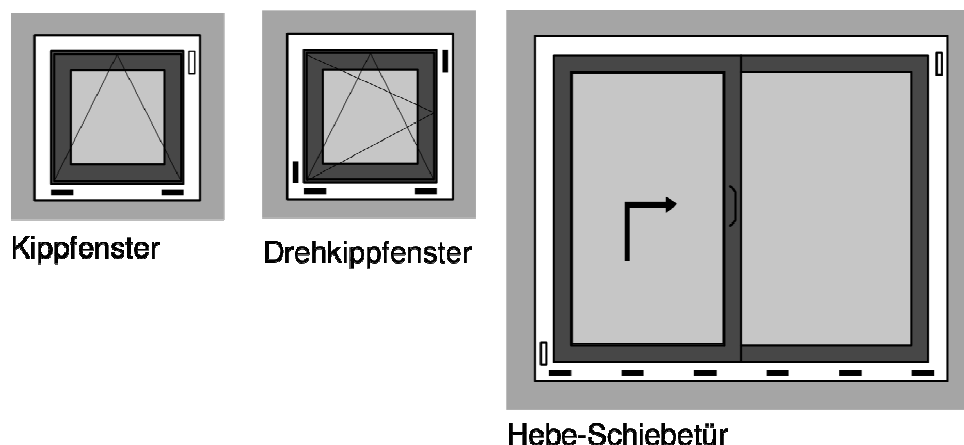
Disposizione dei sostegni e distanziatori (tratto da Fenstermontage - Grundlagen)
